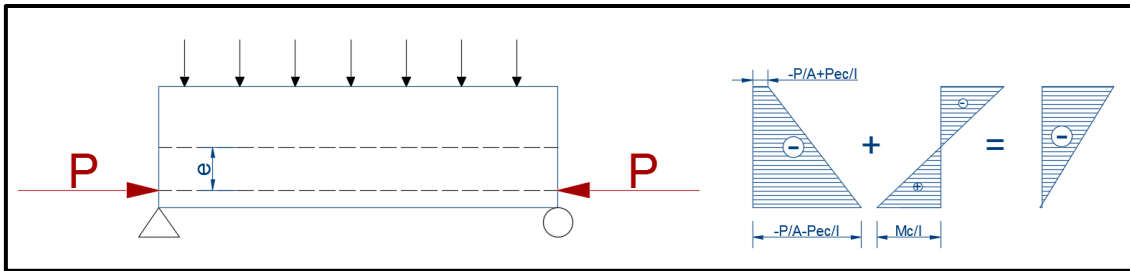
Viga simplemente apoyada con presfuerzo y sometida a fuerzas transversales. Perfil de esfuerzos (Adaptado de Nawy, 2002).
